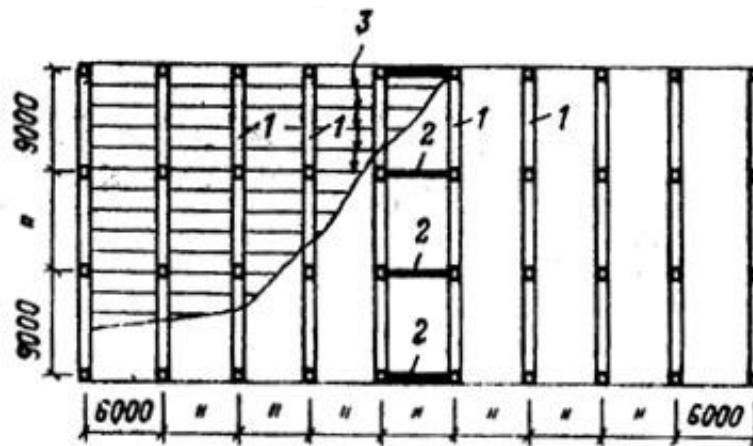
Конструктивный план многоэтажного каркаса промышленного здания
